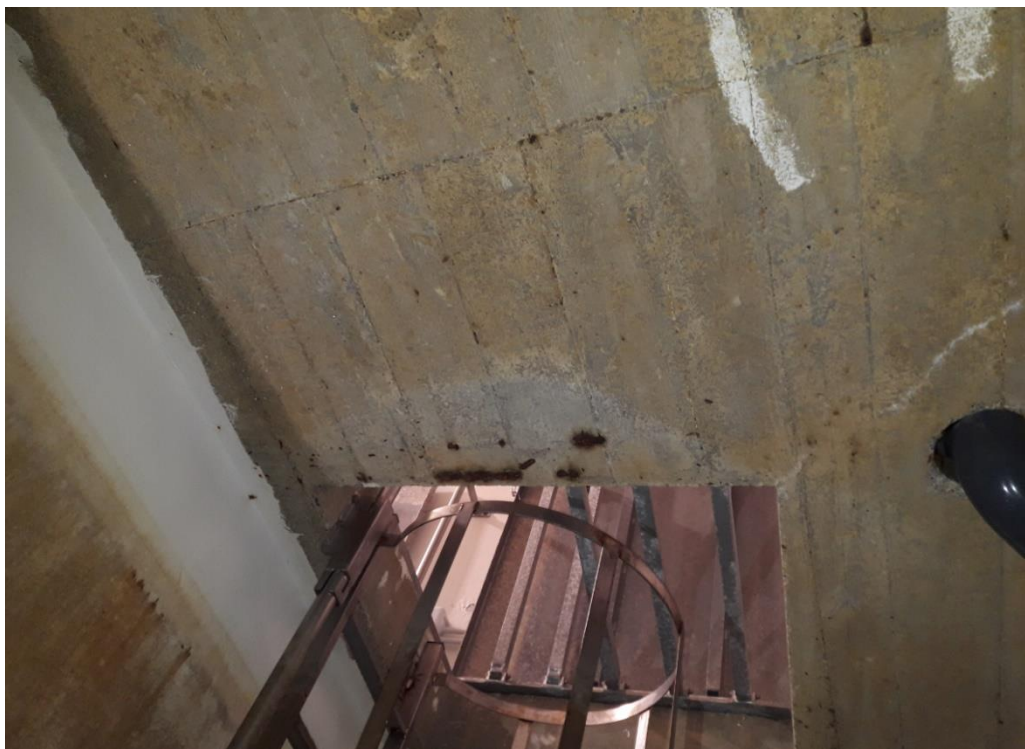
Désordres de type 2 et 3 – Fissure dalle haute de la bâche
